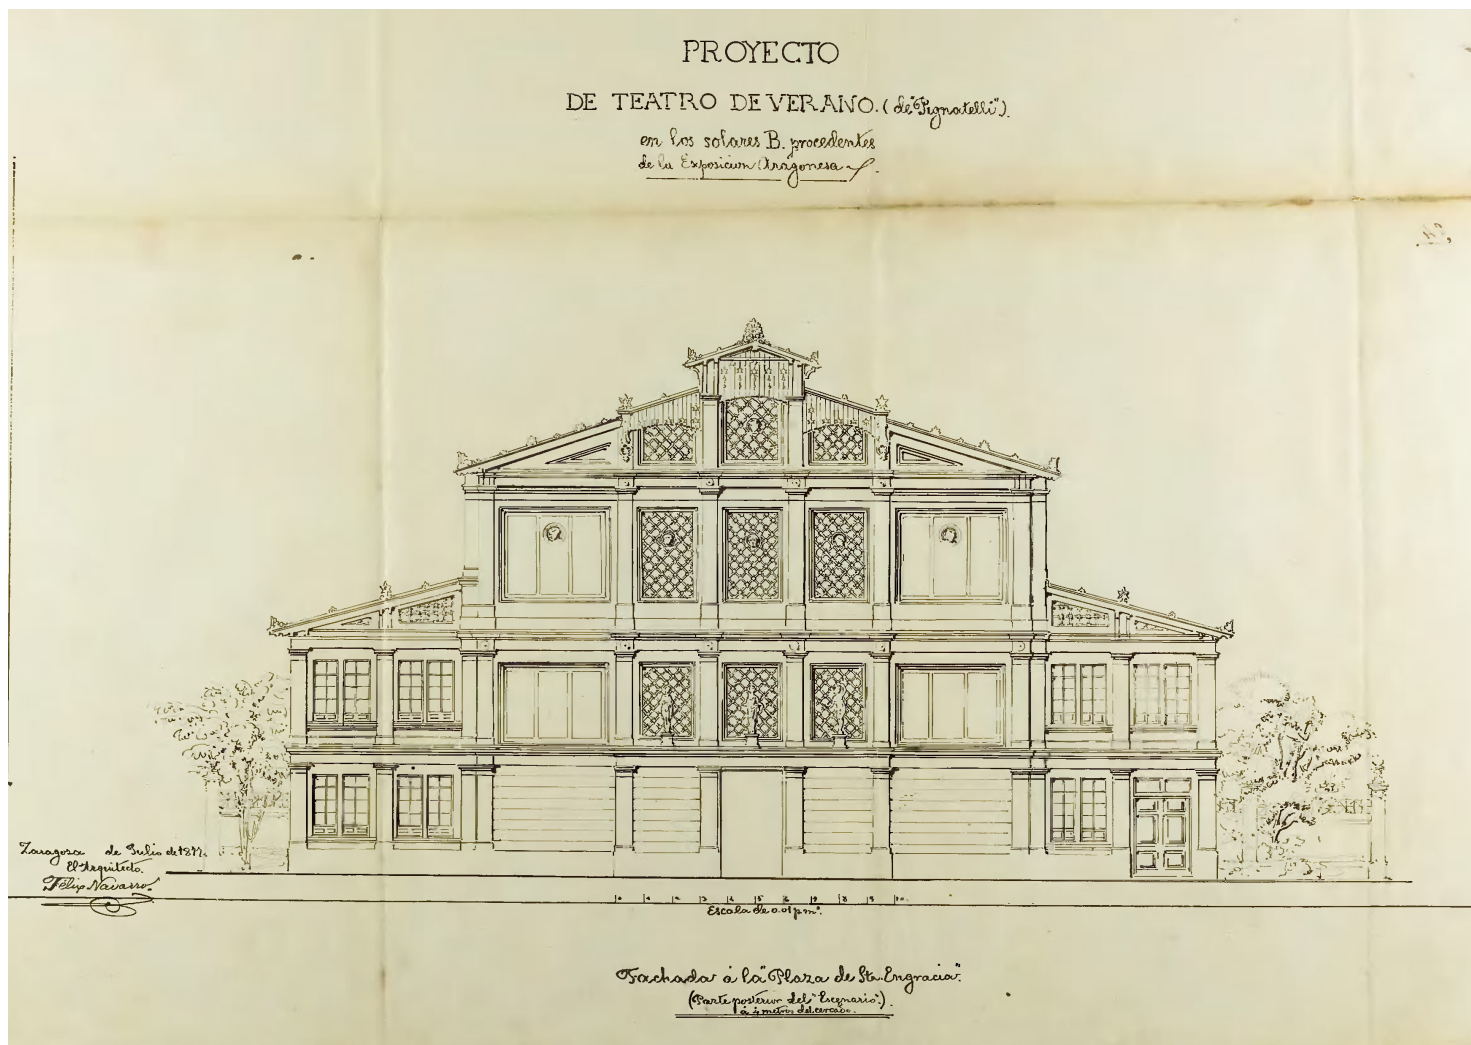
Alzado frontal original del Teatro Pignatelli dibujado por Félix Navarro en 1877. Fachada a la Plaza de Santa Engracia.
